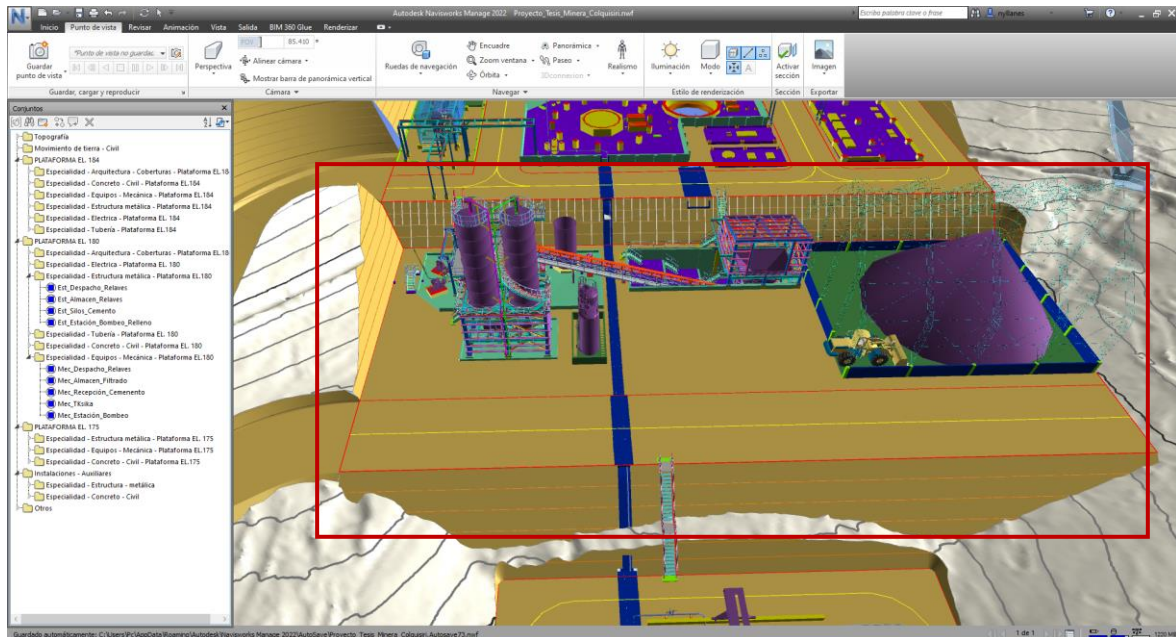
Importación de los modelos de Modelos estructura metálica y equipo mecánico en planta.
